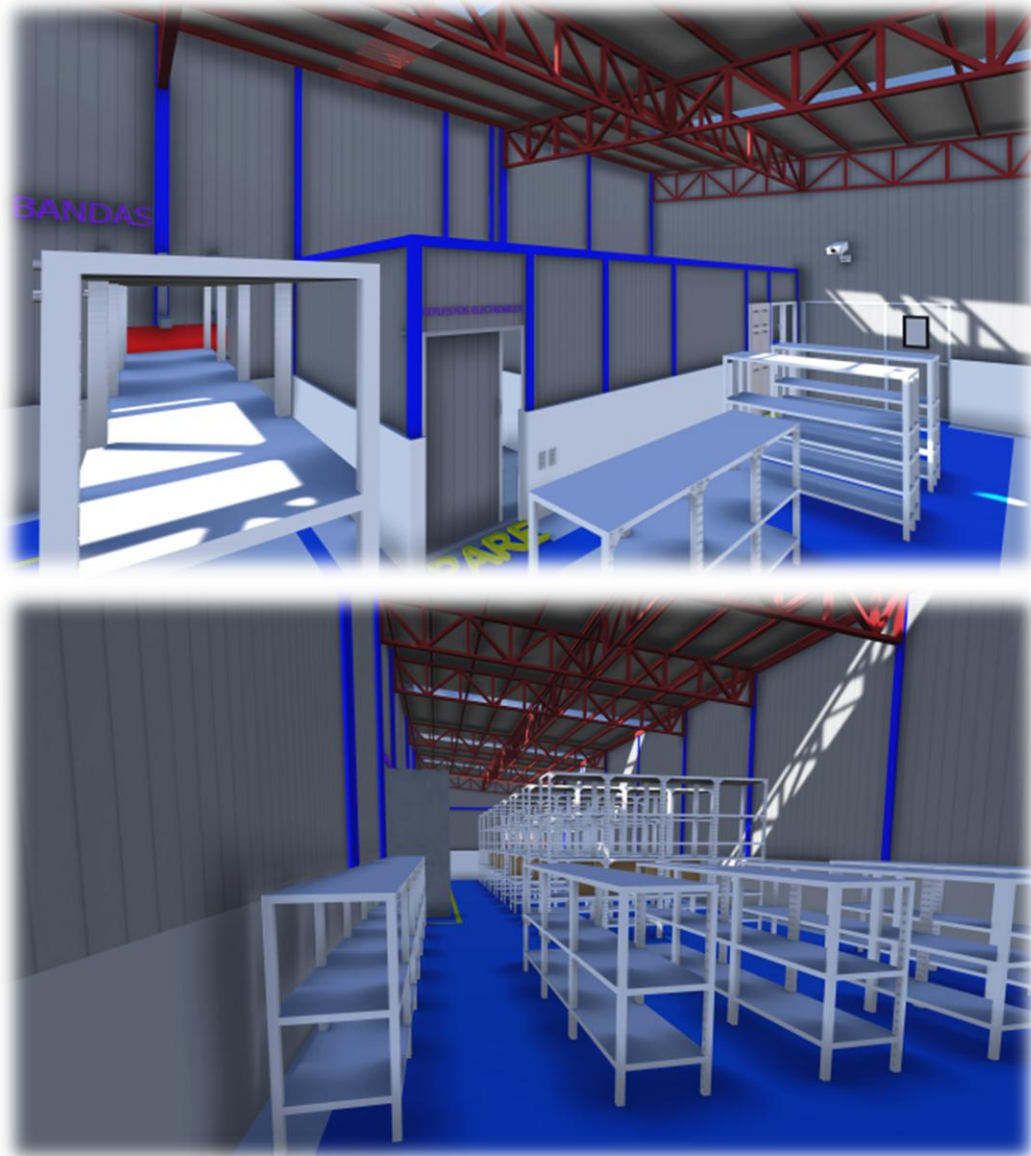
Planta de cuarto de soldadura. Fuente propia
